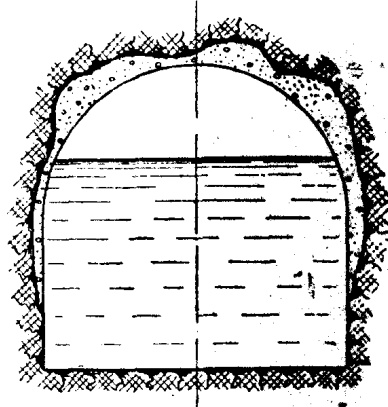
岩質层内无衬砌水利工程隧道截面图 (为了整平坑壁表面减少其凹凸以及加固裂缝起见, 需在整个壁上涂以不同厚度的混凝土层)
